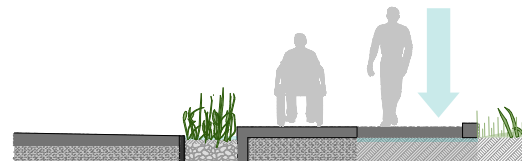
Pavimentos permeables y accesibilidad, Elaboración propia
